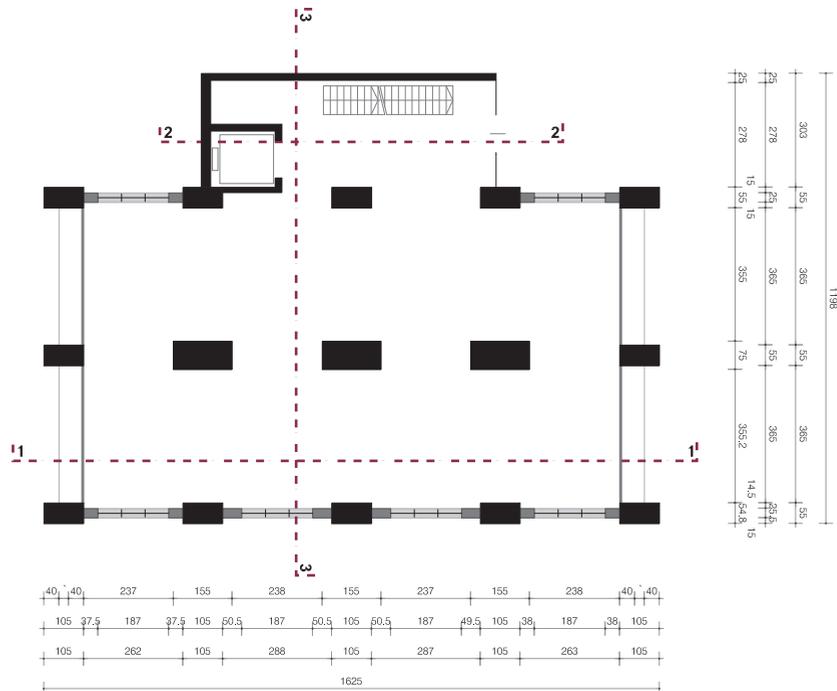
Grundriss Erdgeschoss Bestand
